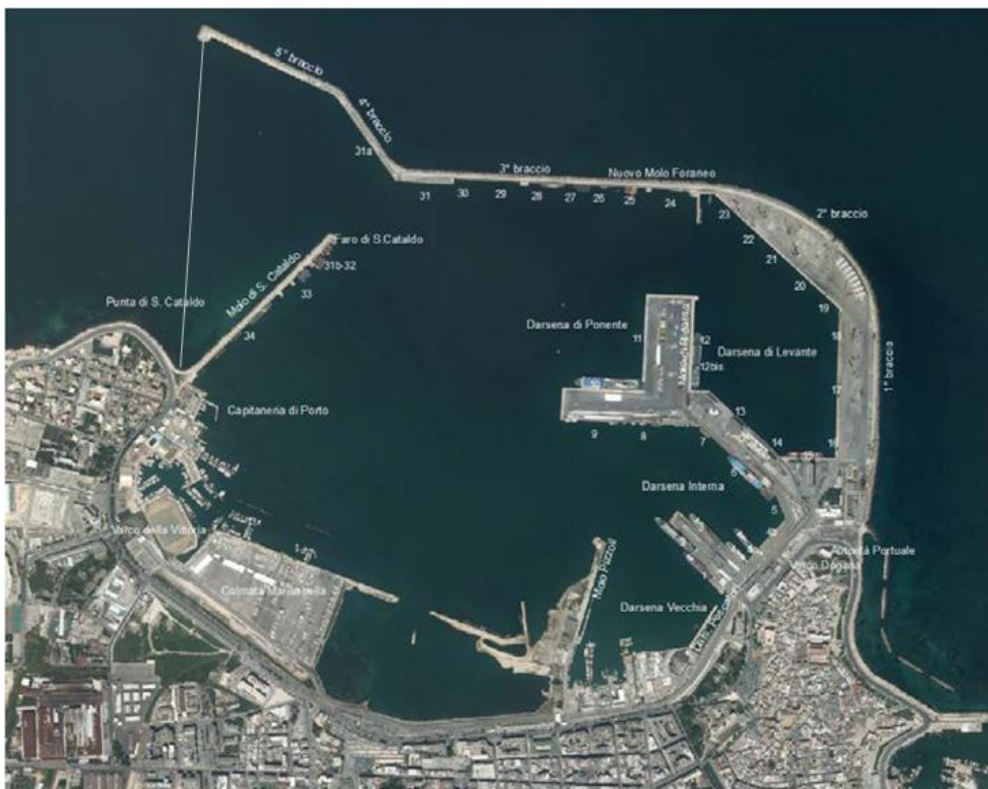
Planimetria del porto di Bari – Sito di Intervento
